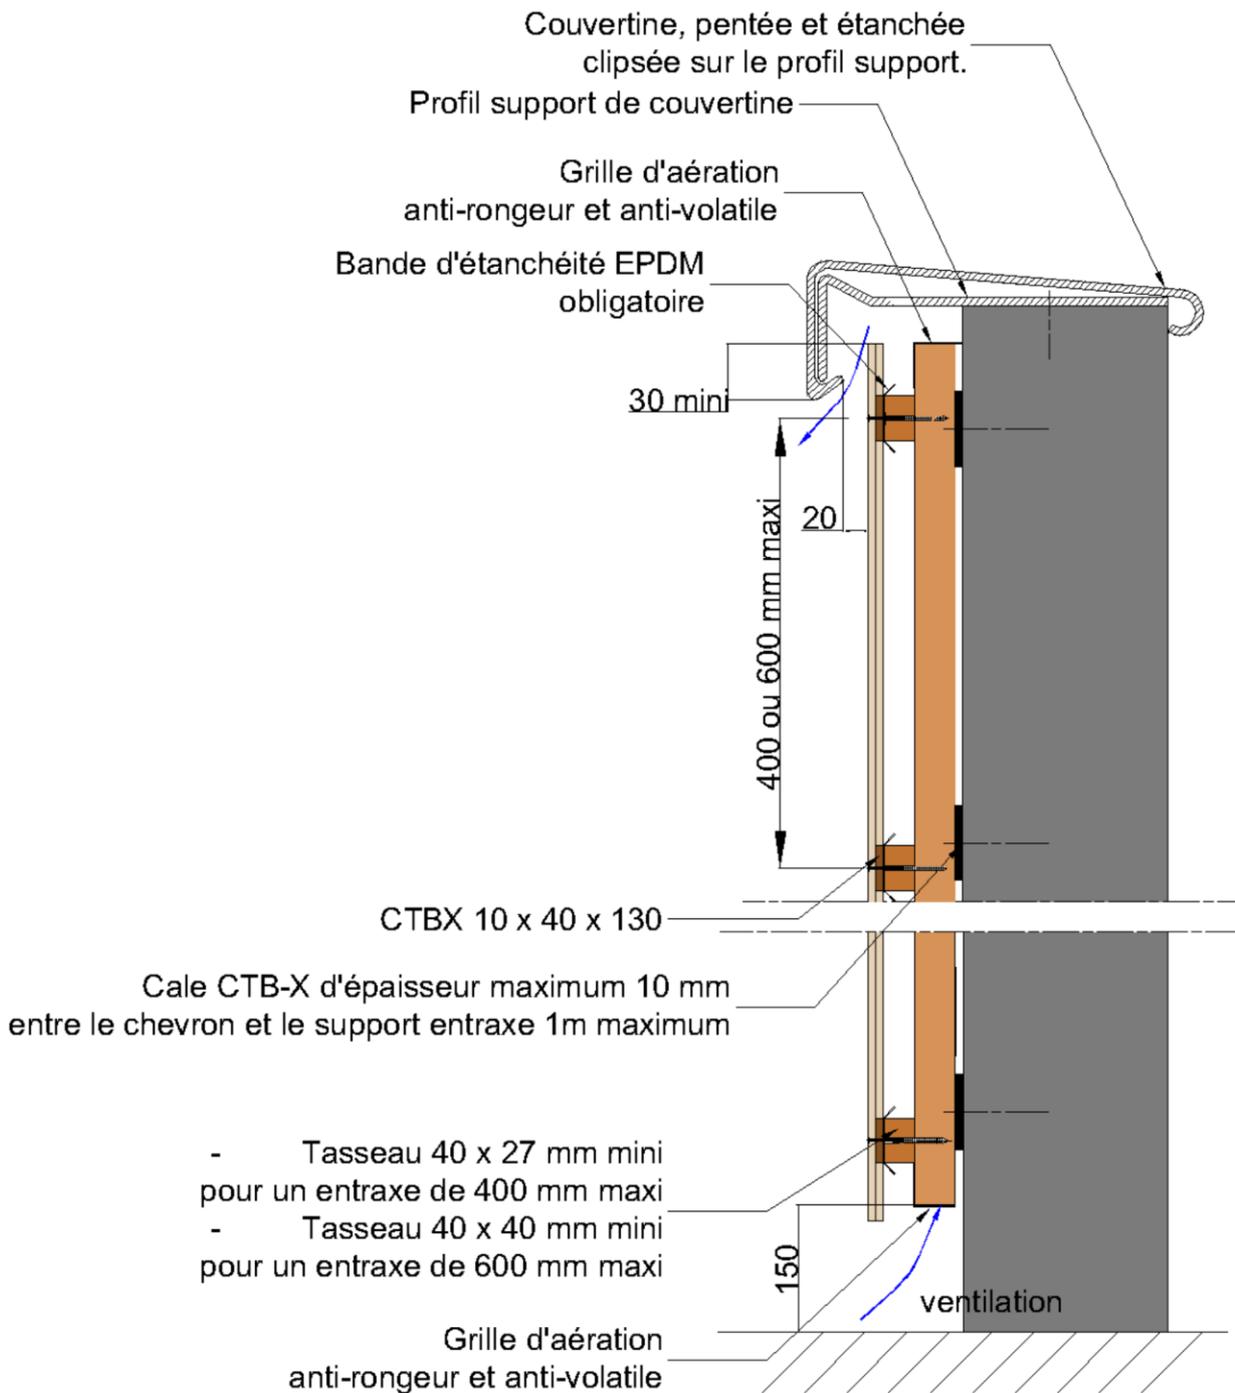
Rive haute et rive basse avec acrotère – pose verticale des lames CEDRAL LAP sans isolant
